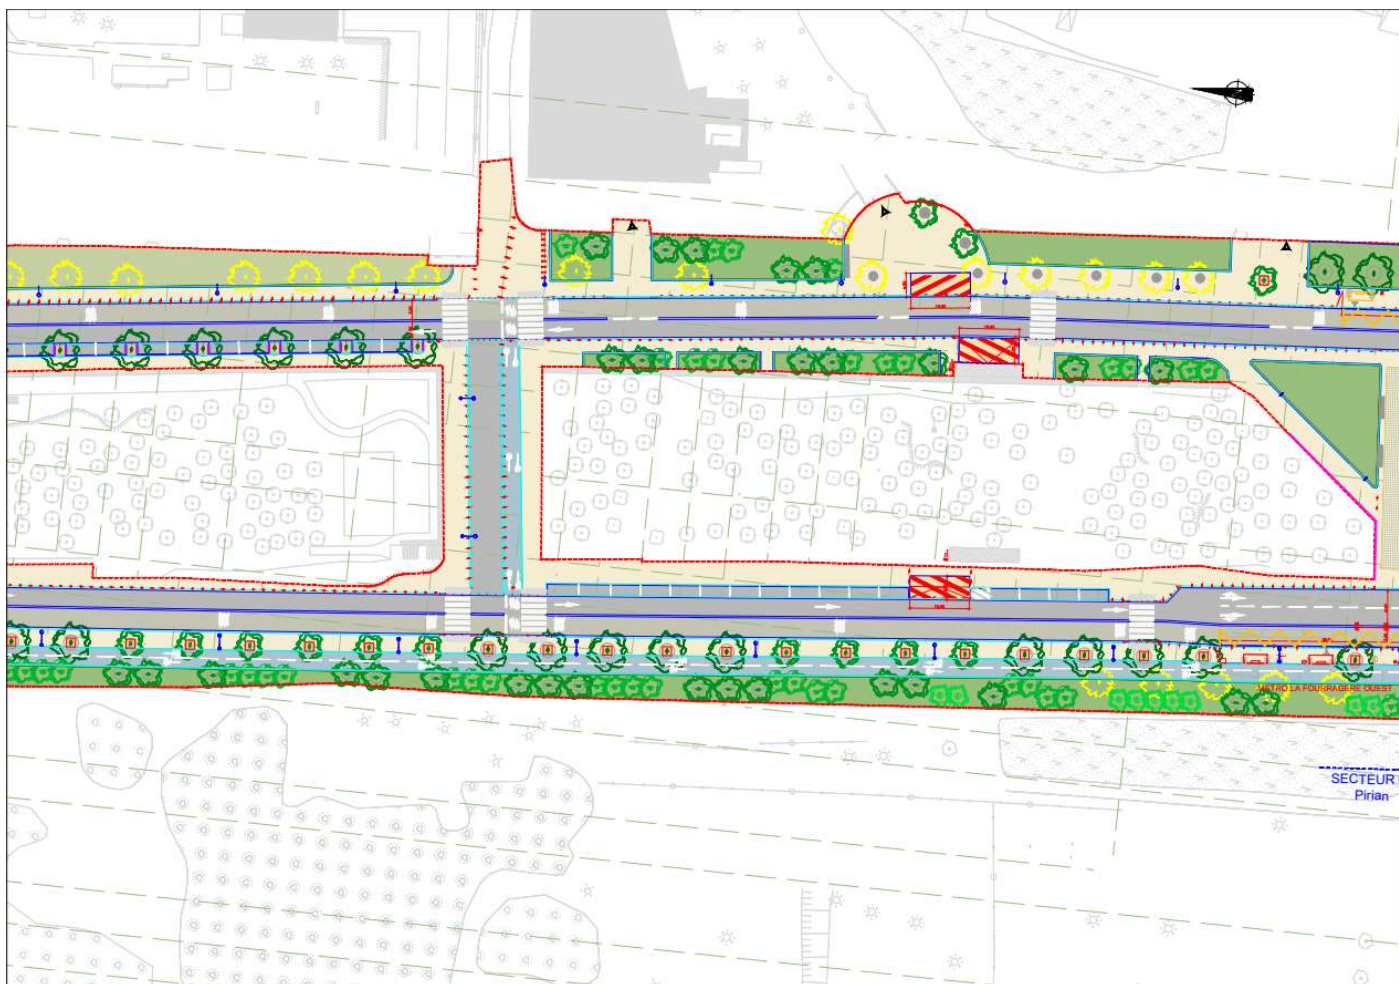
Plan de masse secteur St Julien - La Fourragère 2/3
